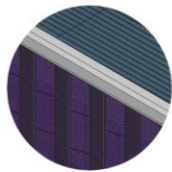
Diagrama constructivo de cubierta, Elaborado por el autor
